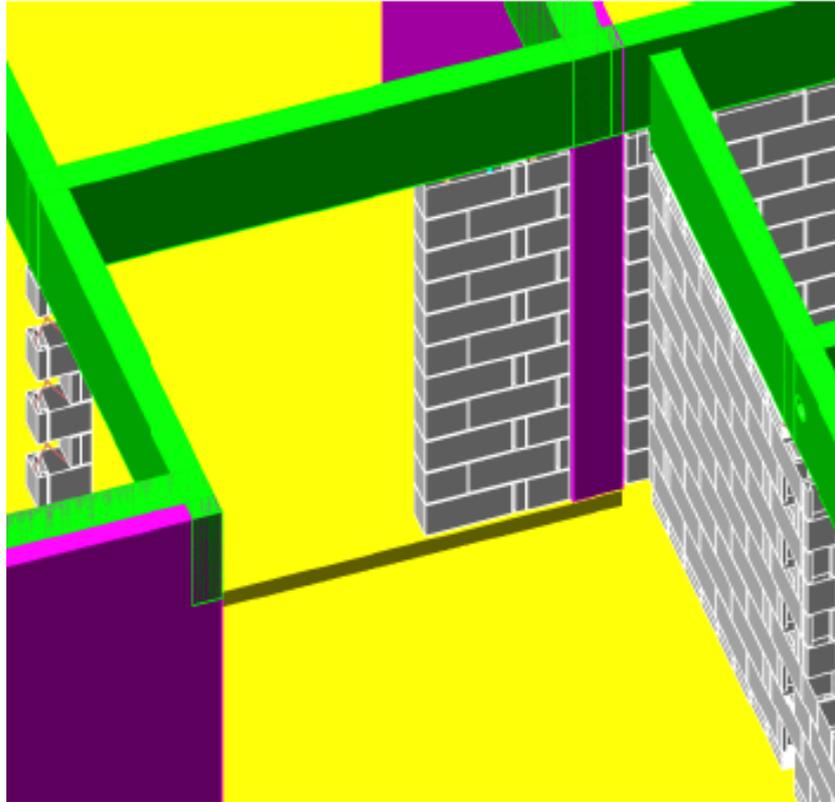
Vista geral das “paredes externas” (em cinza) e da estrutura (pilar em magenta e vigas em verde)
